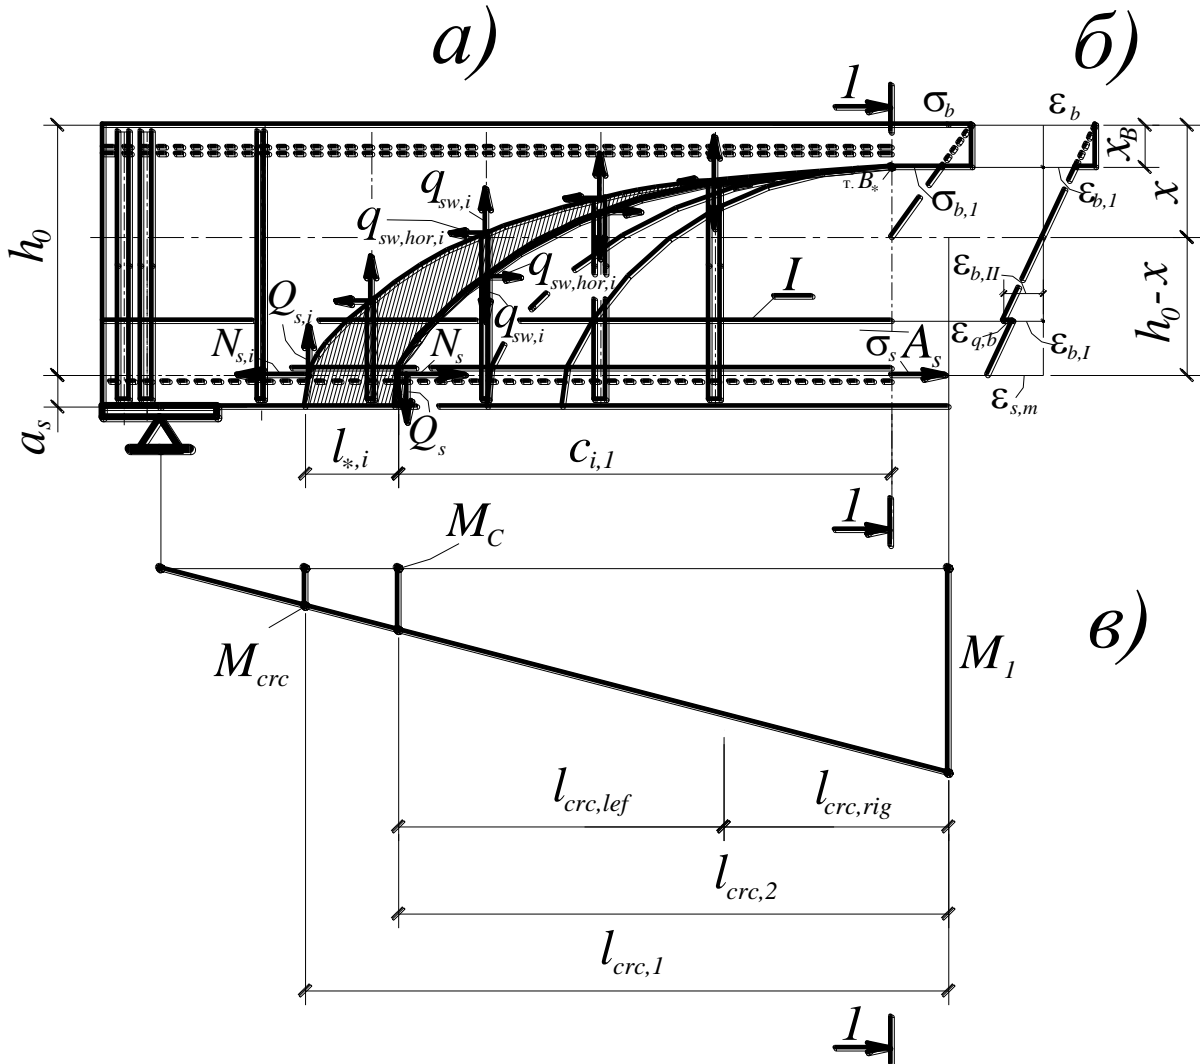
Расчетная схема для определения усилий в сжатом бетоне, продольной и поперечной арматуре в трещинах, образующих веер 1, прилегающий к сосредоточенной силе: а – схема последовательного выделения арок, прилегающих к опасной наклонной трещине и к смежным трещинам; б – эпюра средних деформаций в сечении 1–1; в – схема для определения последующих уровней расстояния между трещинами I – шов между бетонами
